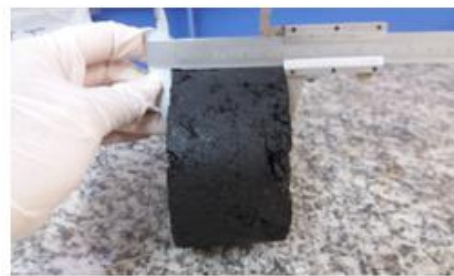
Moldagem de corpos de prova tipo Marshall
